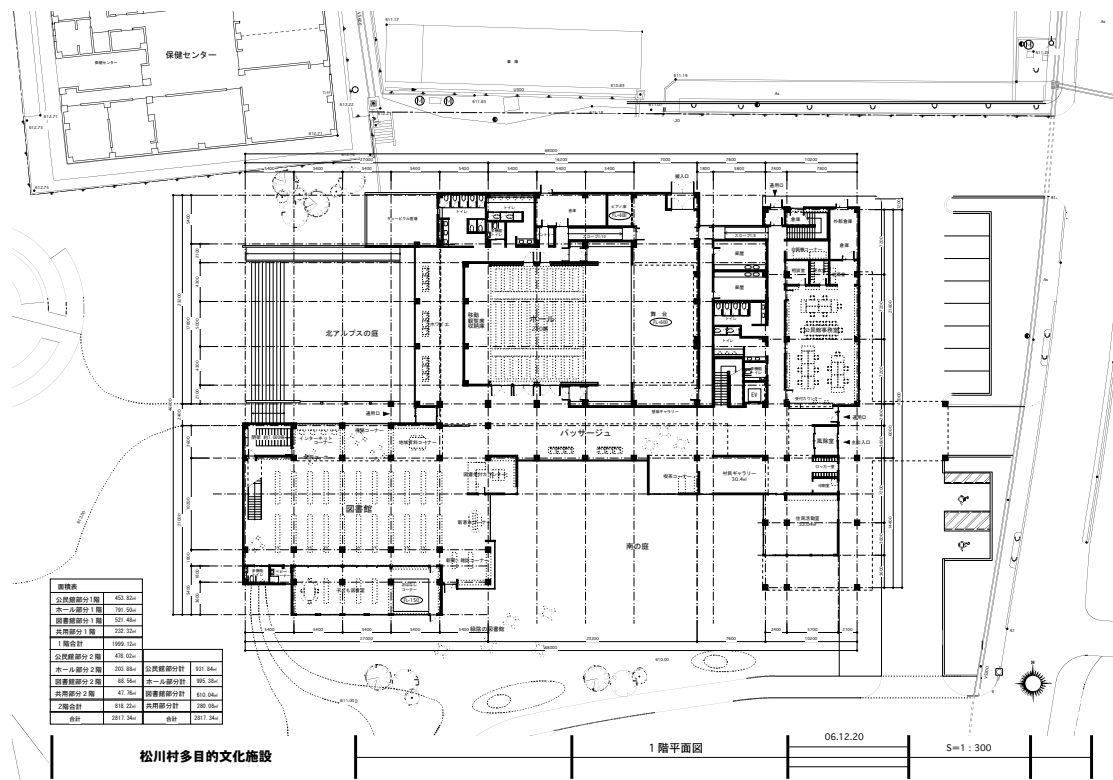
Der letzte Stand des Grundrisses Erdgeschoss beim Planungsausschuss (ebd. No.6)
